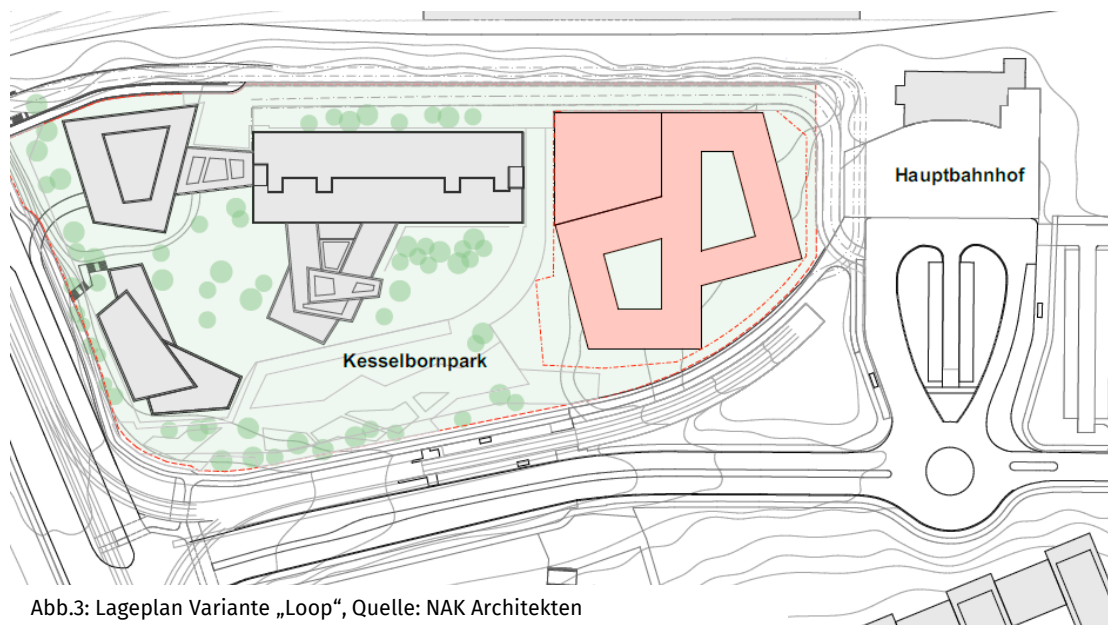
Lageplan Variante „Loop“, Quelle: NAK Architekten
